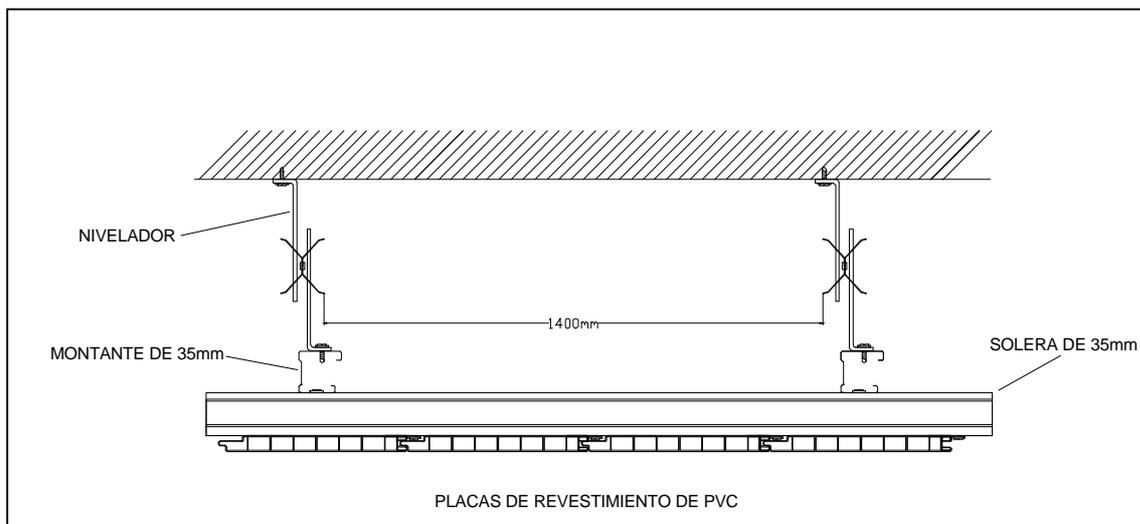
Estructura de sostén suspendida (Vista en corte)
